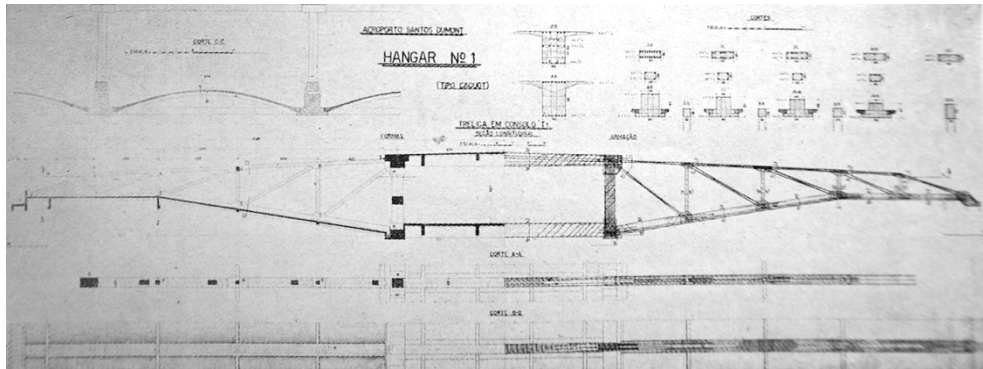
Detalhes da treliça em consolo. FONTE: CONCRETO, 1945.
